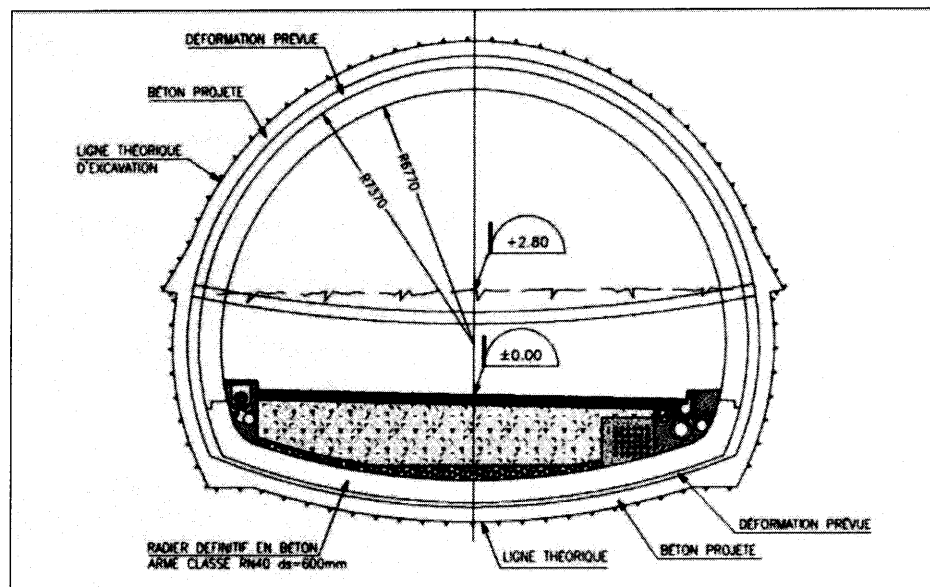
Coupe et gabarit transversal type du tunnel.
